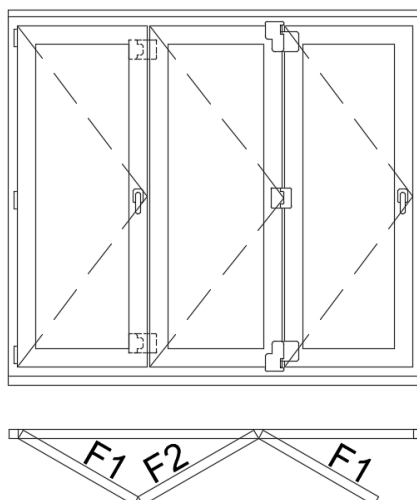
Alçado e planta de vão envidraçado harmónico.
